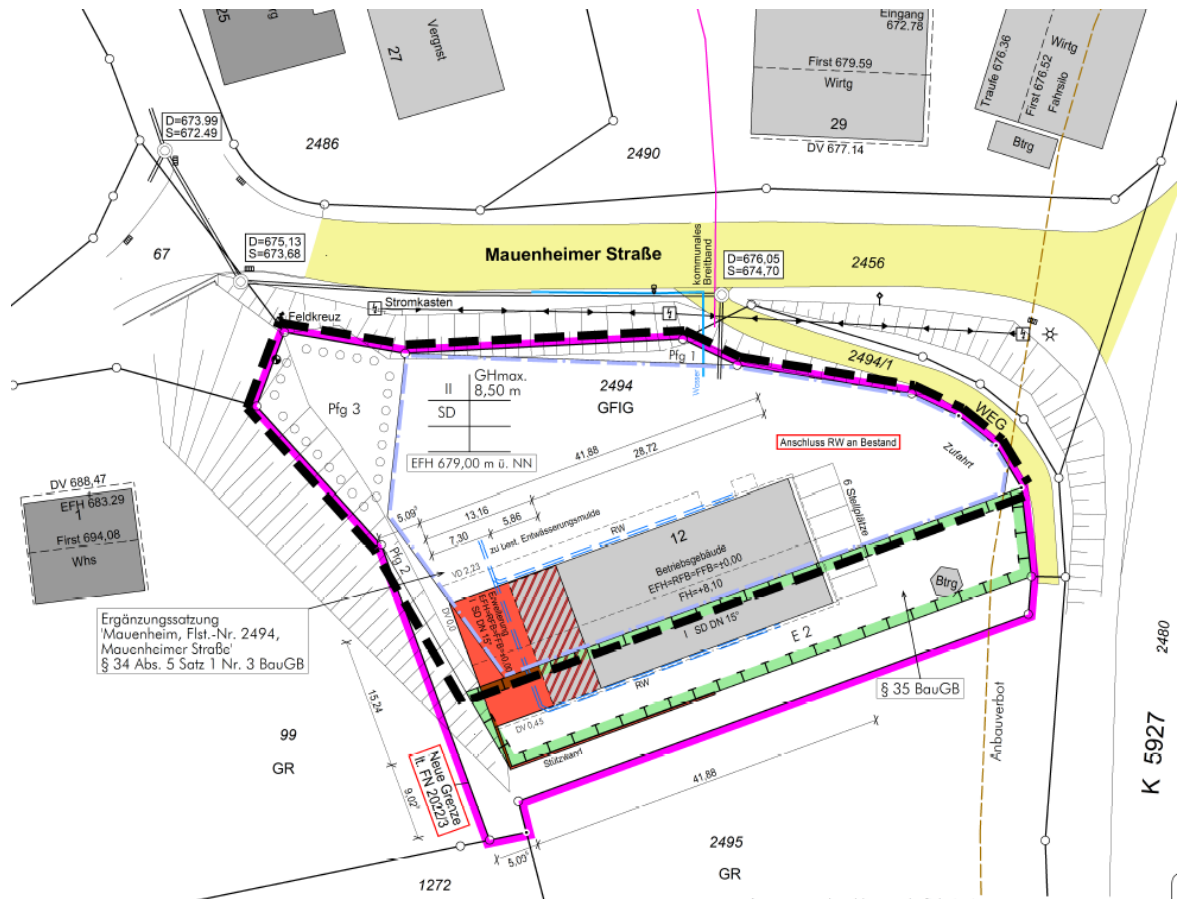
Ausschnitt Lageplan zum Bauantrag, Stand 26.07.2022 (Quelle: Griefshabe + Oberfell GbR)
